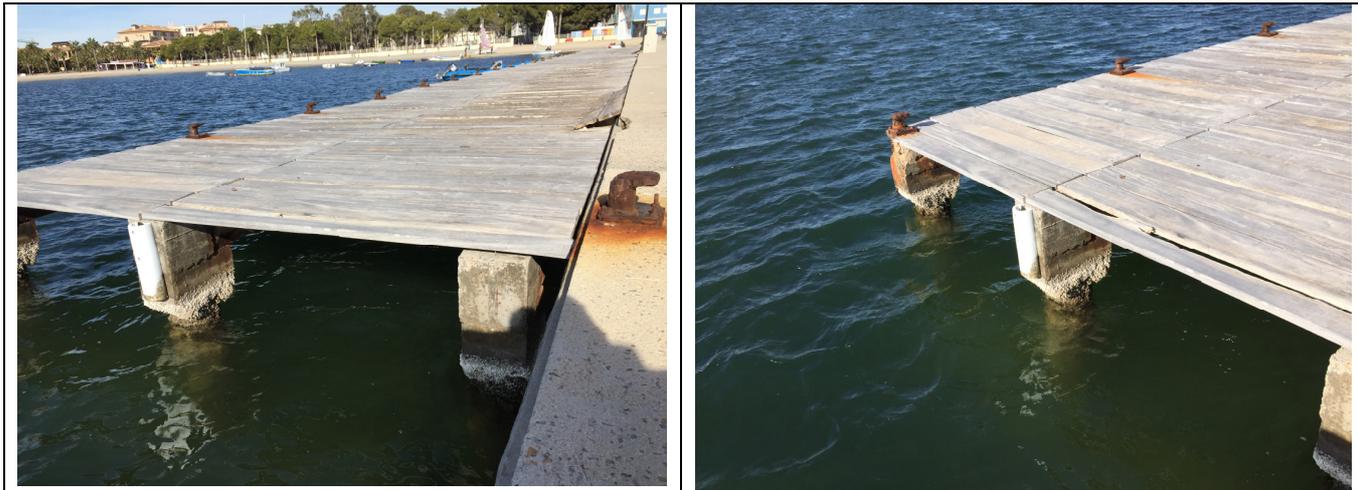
VISTA BORDE UNIÓN PANTALAN-EMBARCADERO
